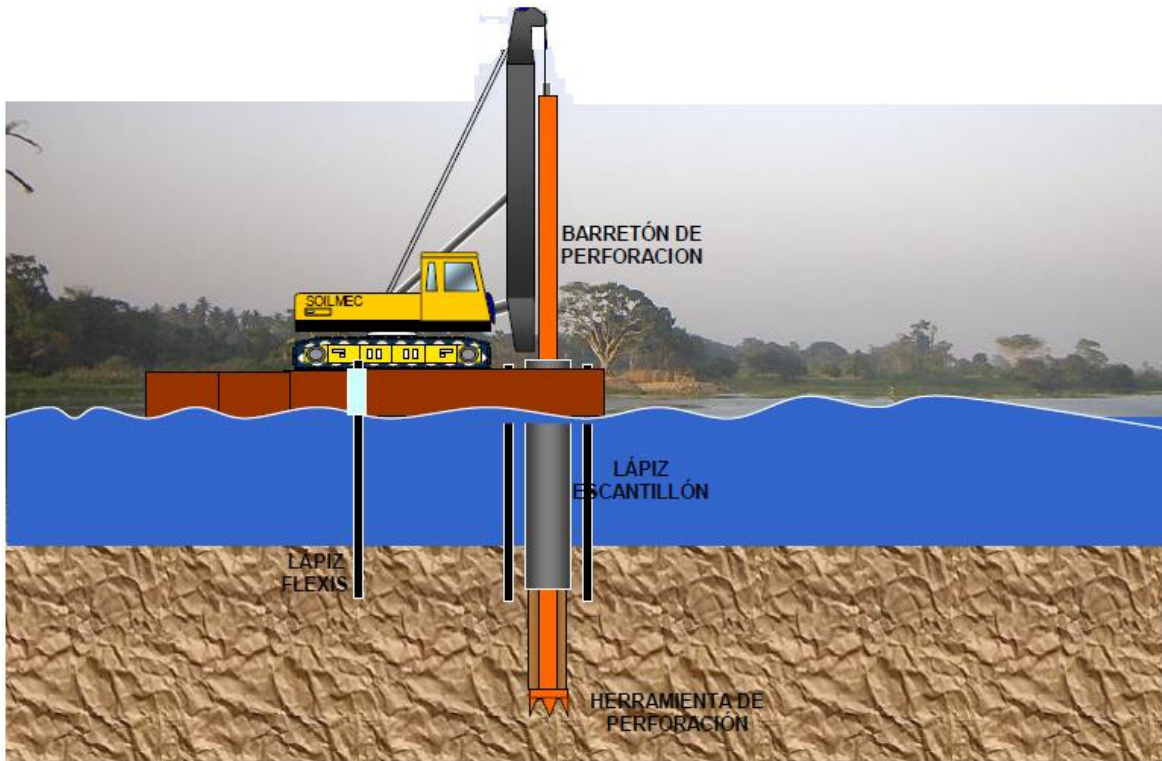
, Perforación de Pilas con Barretón y herramienta de perforación.
